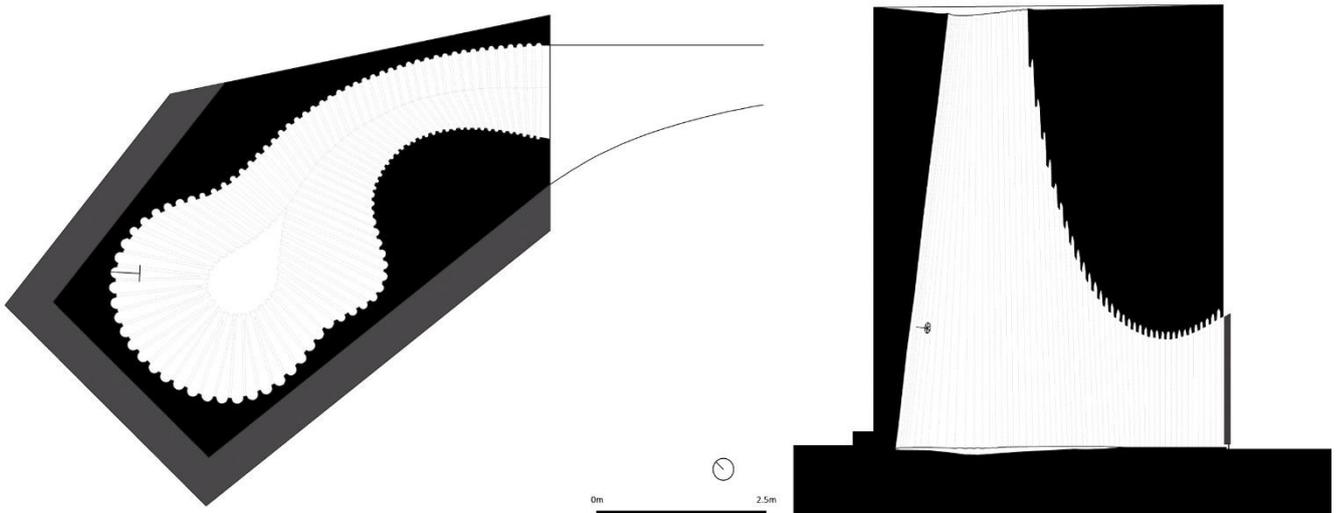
e 17 - Planta Geral e Corte da Capela Bruder Klaus.
